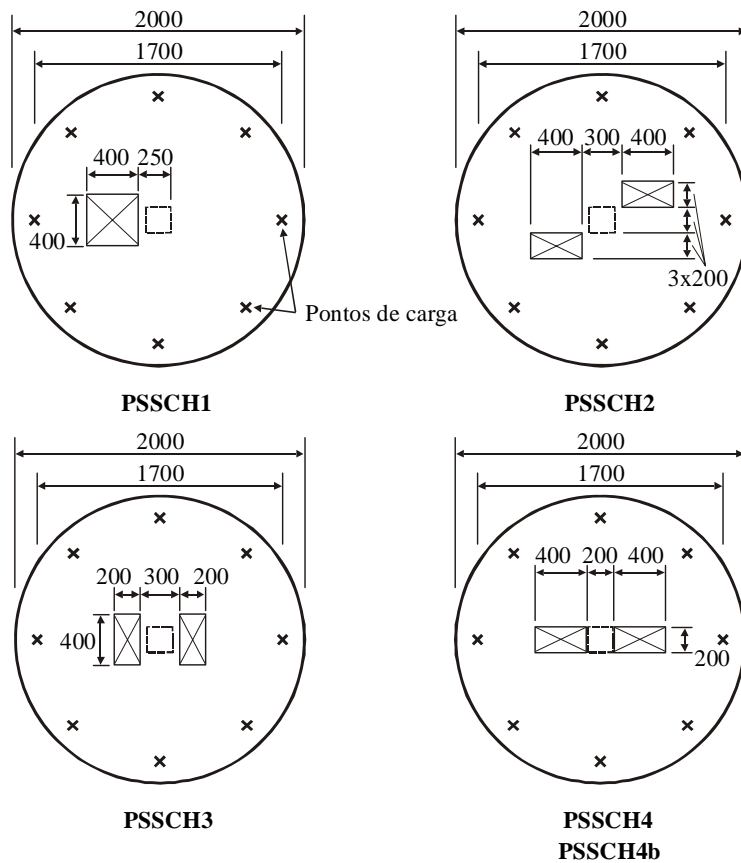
Lajes ensaiadas por IOANNOU (2001) (mm)
